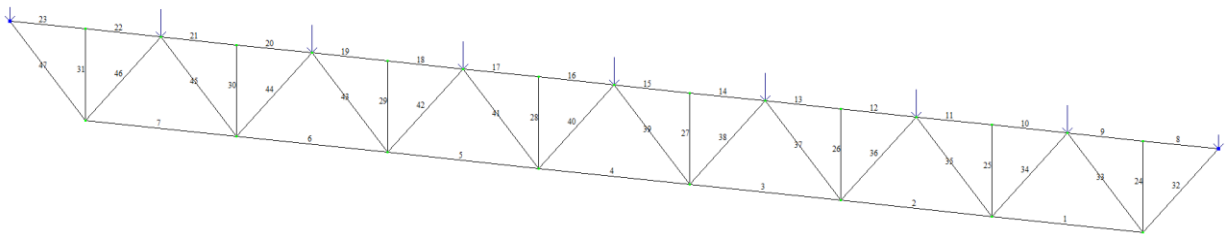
Загрузка фермы снеговой нагрузкой
